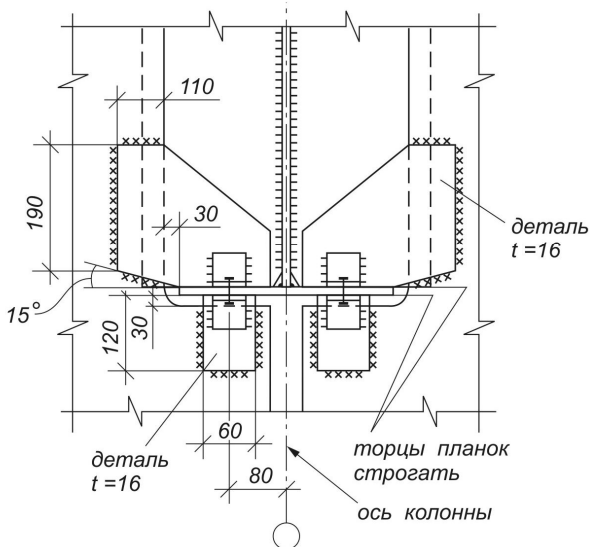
Сопряжение разрезных подкрановых балок с колонной без тормозных конструкций
